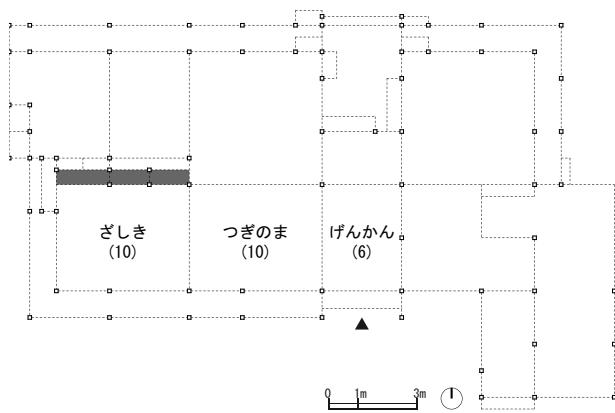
As 家住宅復元平面図（明治 30 年 5 月）
